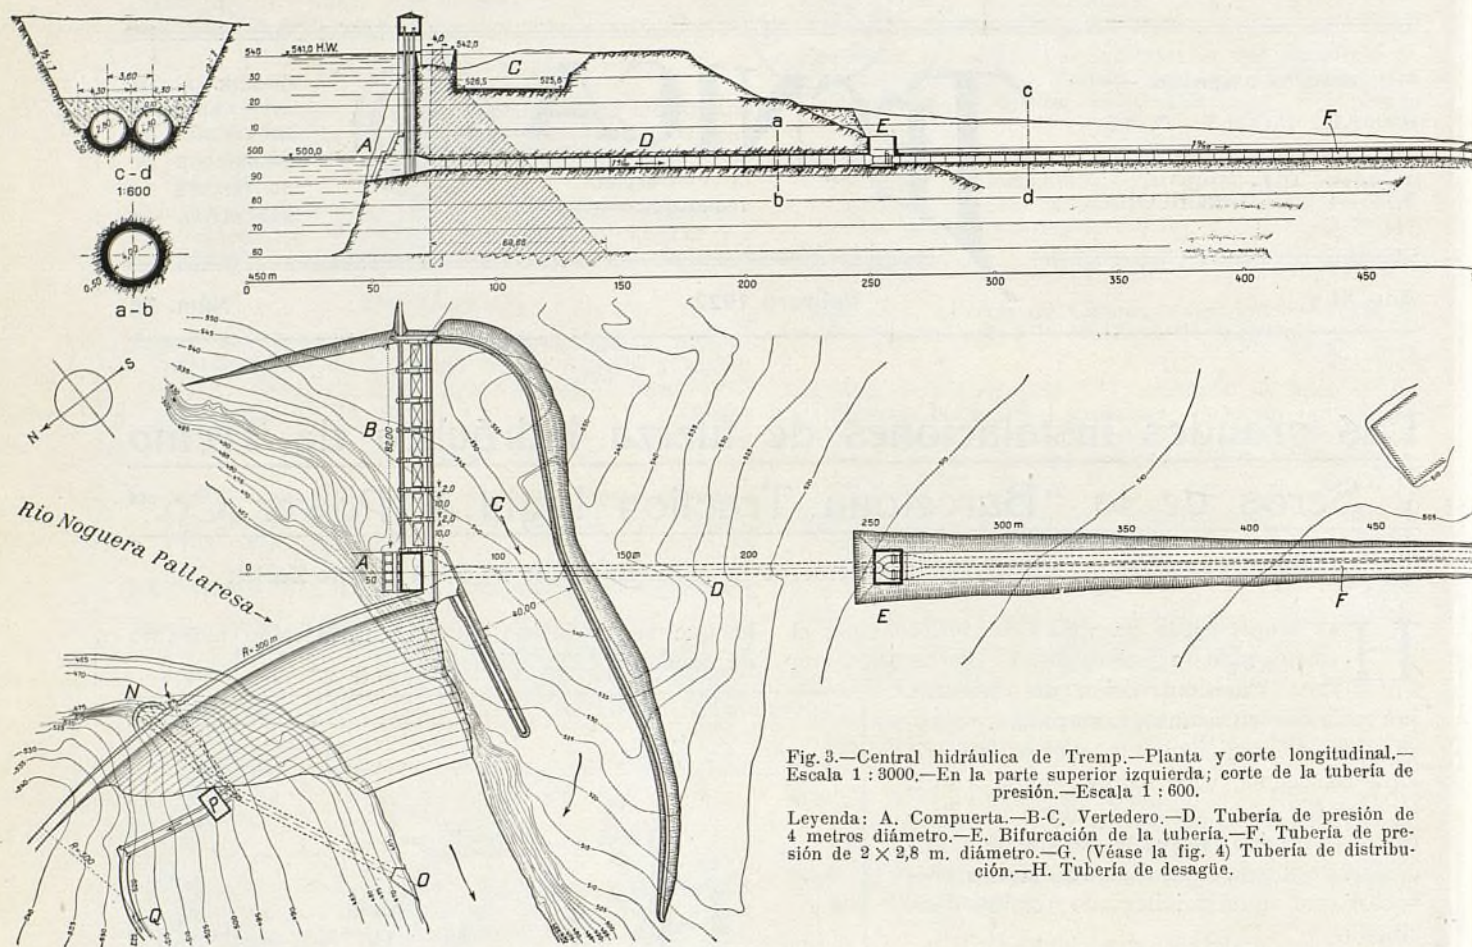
Central hidráulica de Tremp.—Planta y corte longitudinal.—Escala 1 : 3000.—En la parte superior izquierda; corte de la tubería de presión.—Escala 1 : 600.
